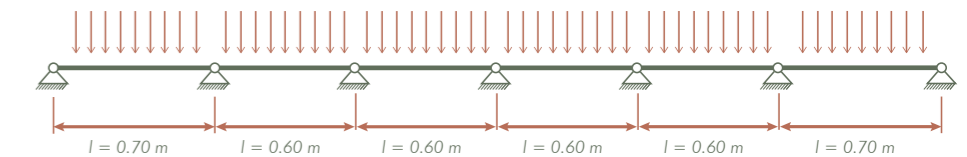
Schema statico trave appoggio - appoggio su sei campate
